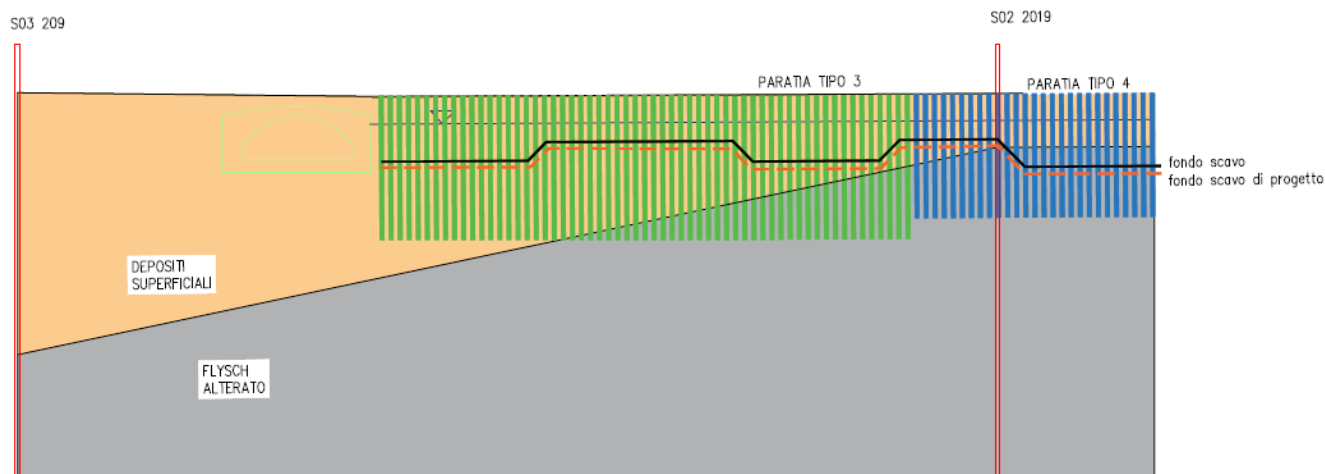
Sezione di scavo con indicazione della profondità dello strato di Flysch
